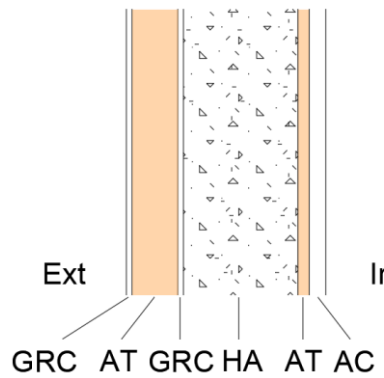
Esquema del sistema constructivo de la fachada de G.R.C. sobre pantalla de hormigón.
